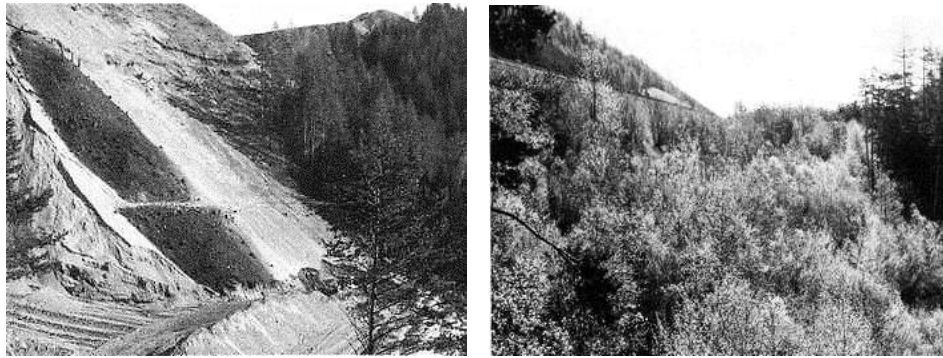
Terraplén estabilizado con lechos de ramaje de setos vivos. Arriba, durante la construcción. Abajo, después de 20 años.
